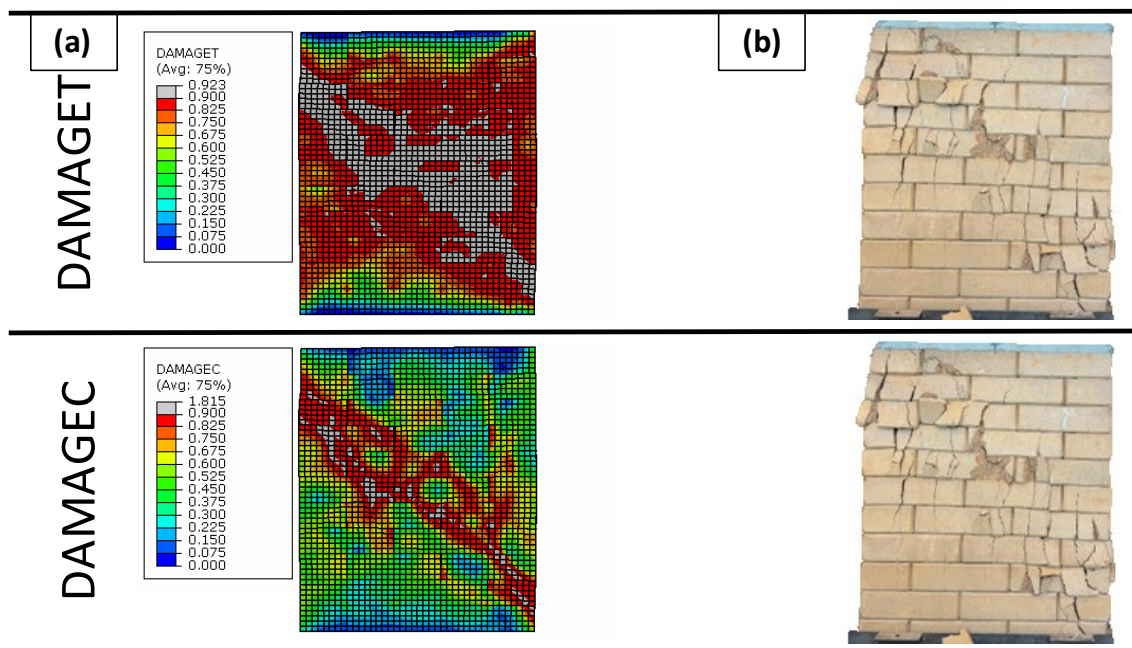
Desenvolvimento de fissuras (a) Caminho de carga e (b) padrões de fissuras.
